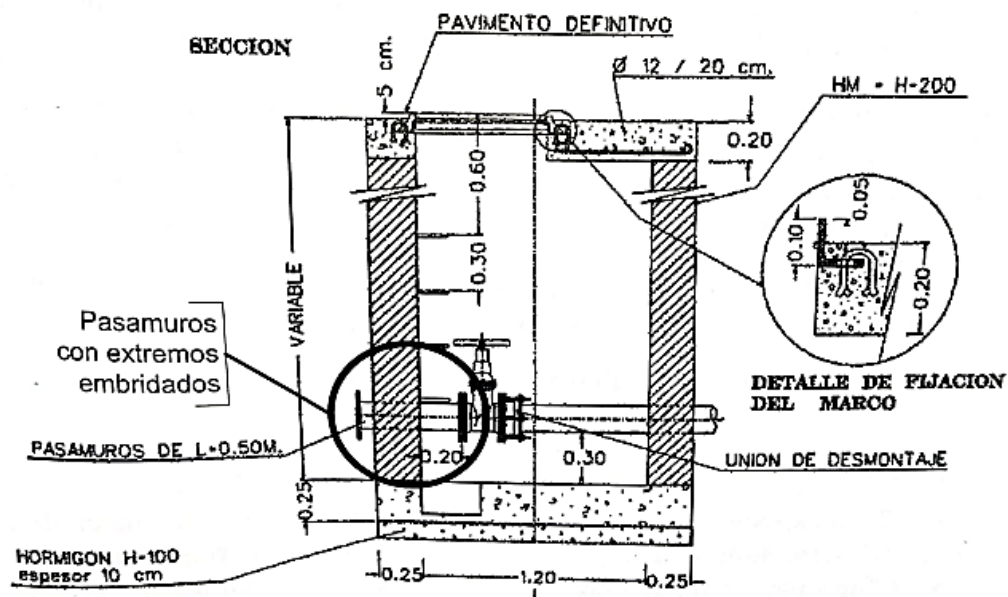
Detalle de pasamuros para la conexión de tuberías y válvulas en obras de fábrica
